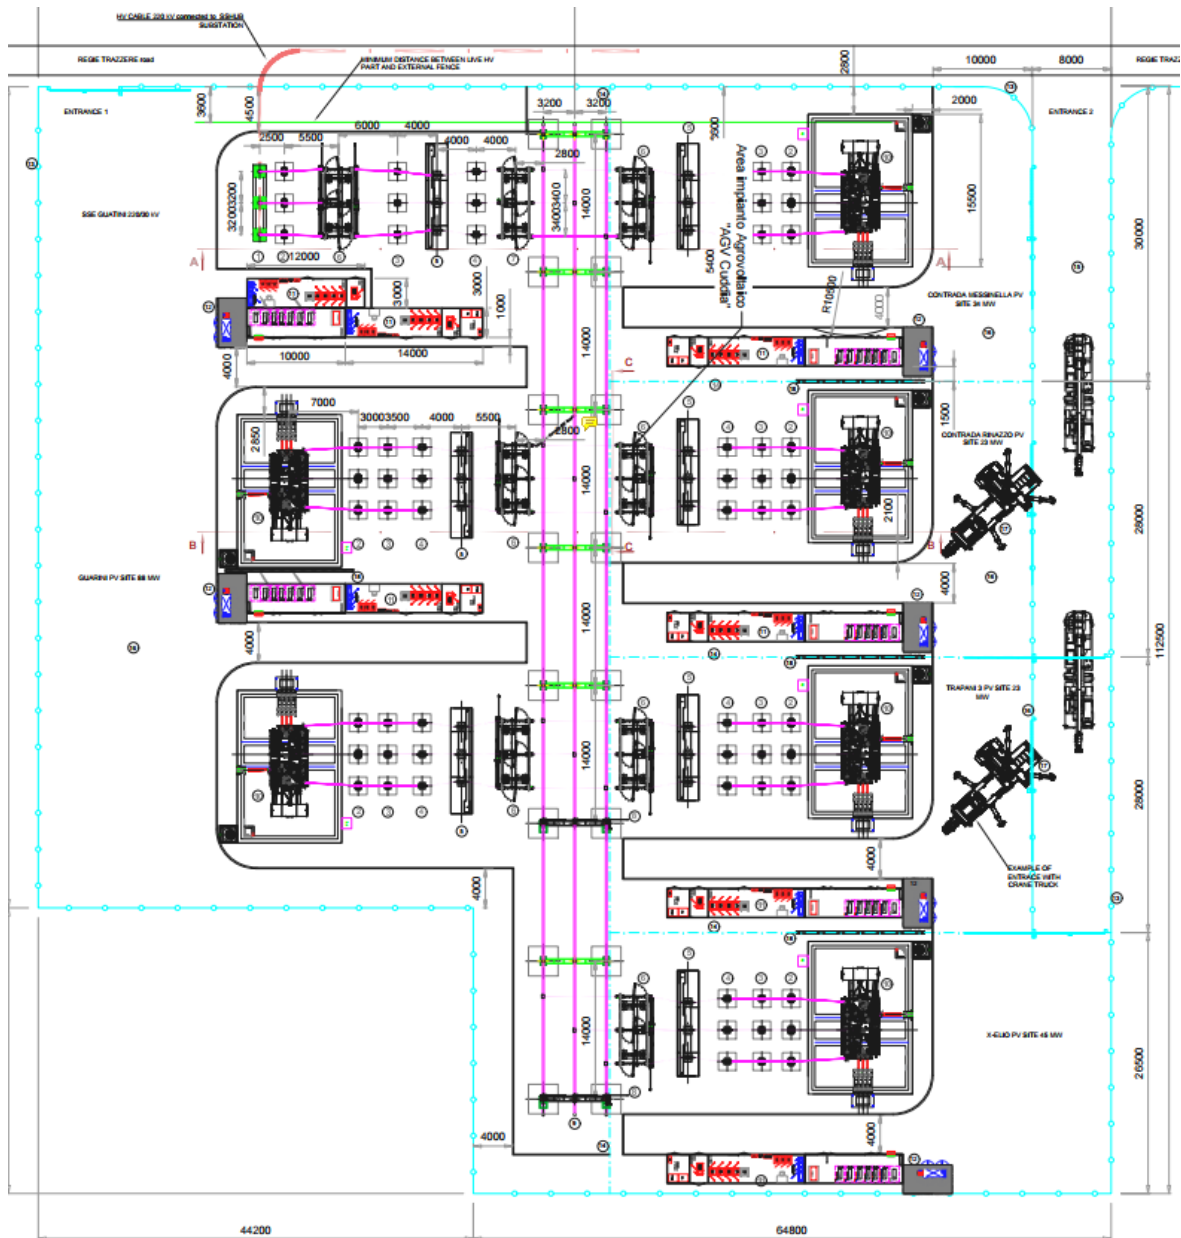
Planimetria opere elettromeccaniche SSE Guarini
